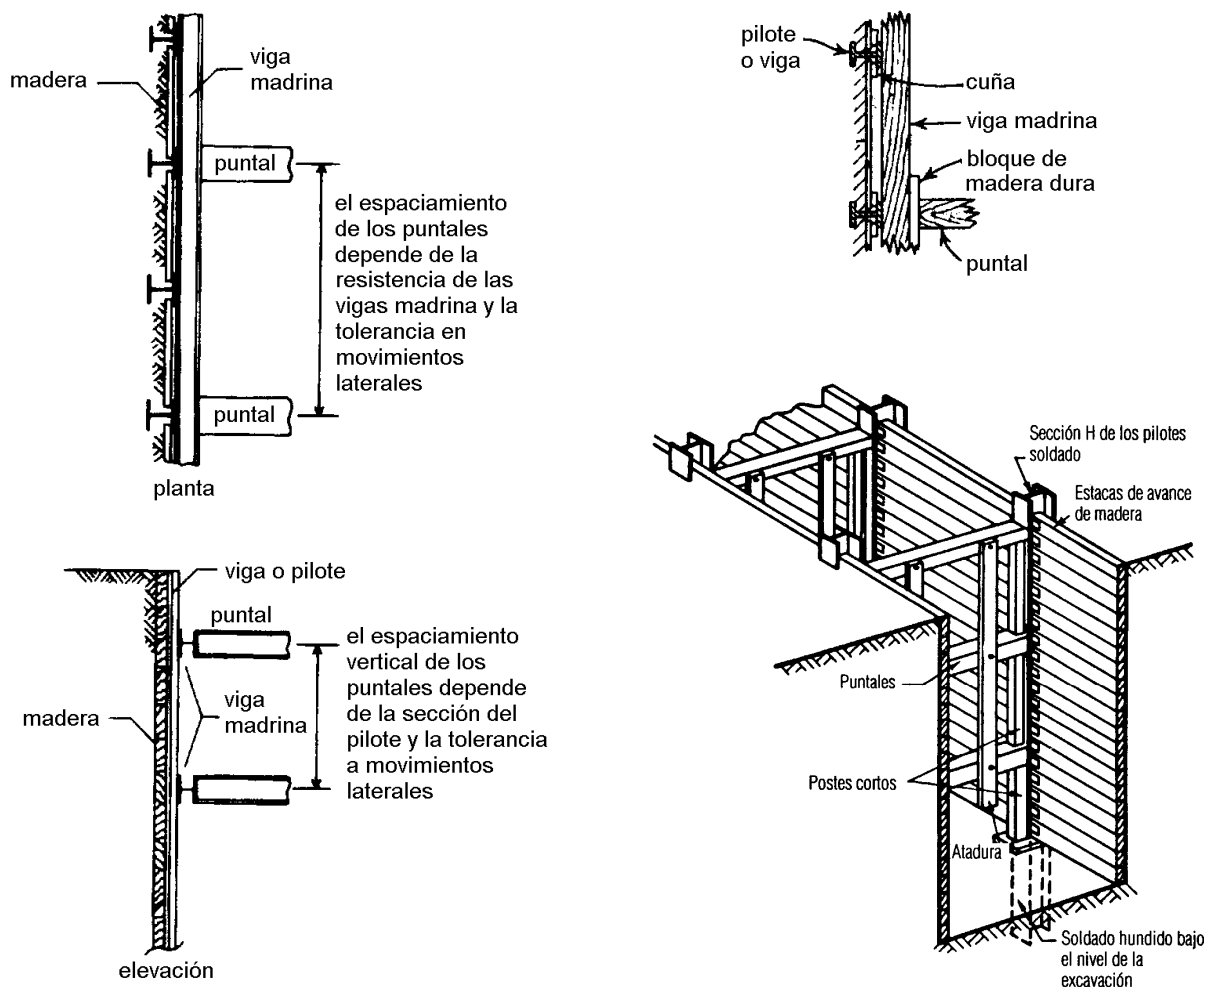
, Esquema general de muro Berlín: vigas, madera y puntales
